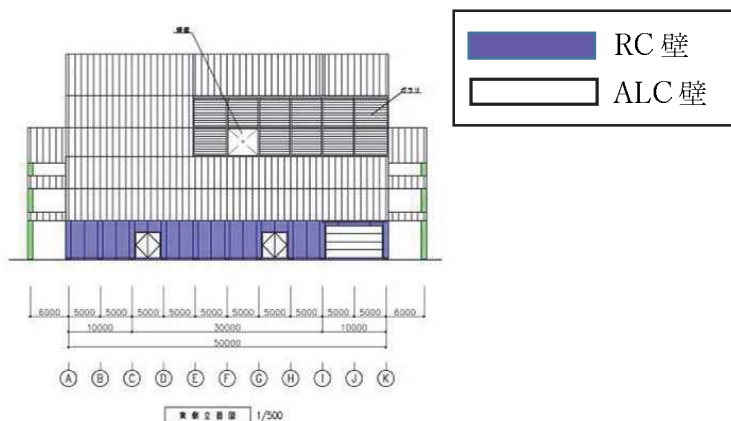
(4) 外壁の配置 (東側立面図)
